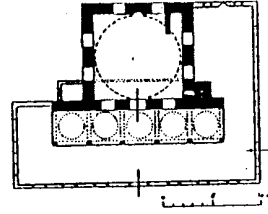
مسقط أفقى لمسجد ياكوفالى
